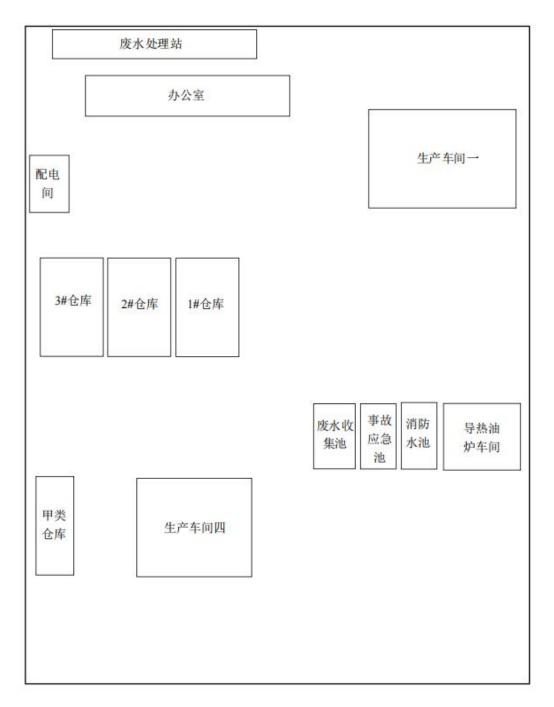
南通恒华粘合材料科技有限公司北厂区平面布置图
